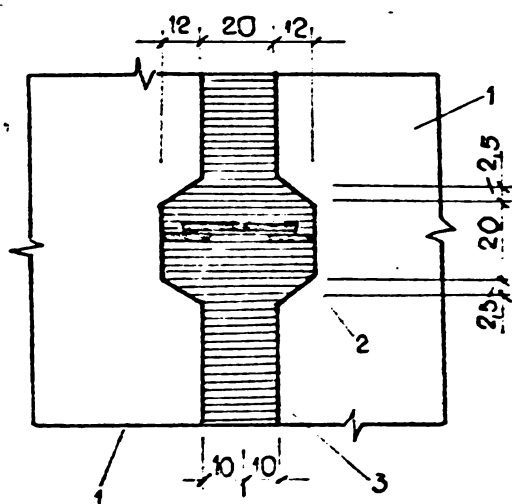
Imbinarea verticală a panourilor pentru elevații: 1-panou elevați; 2-mustăți; 3-beton monolitizare.
